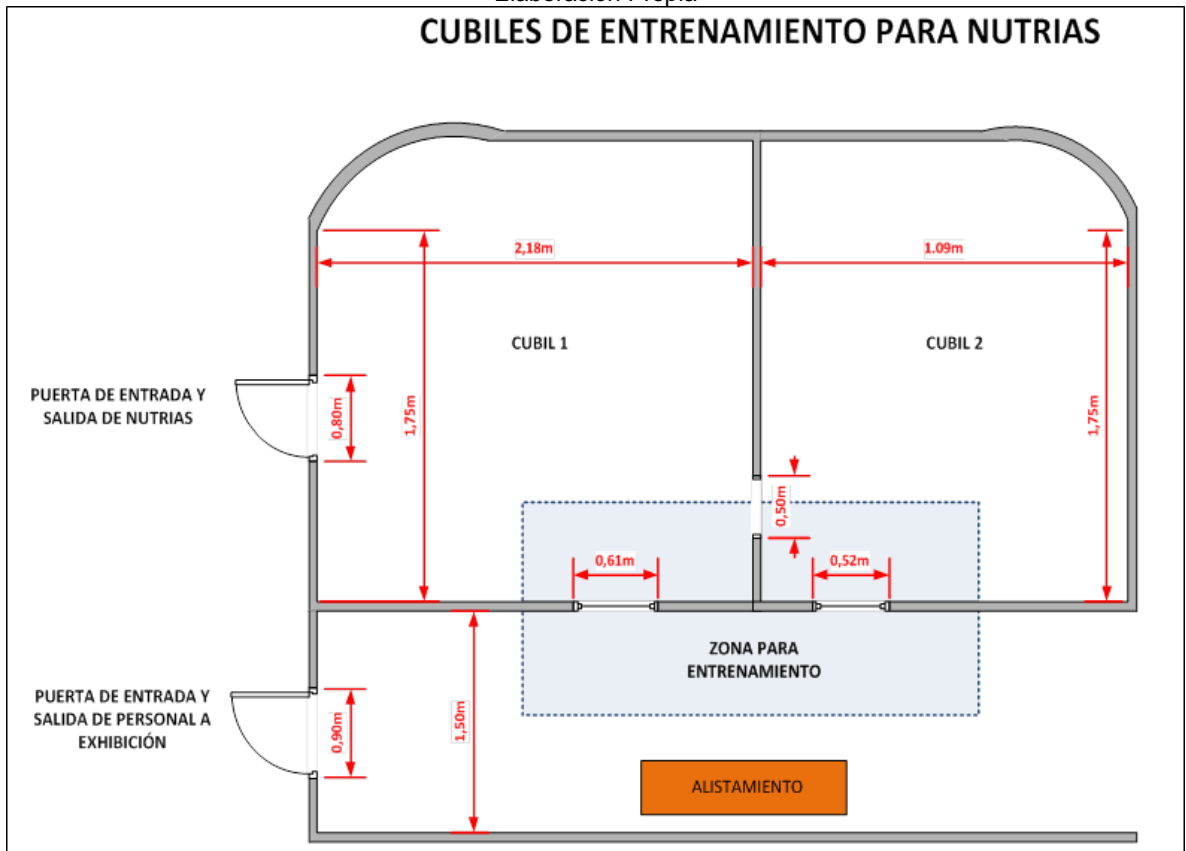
Plano cubil de entrenamiento para las Nutrias
